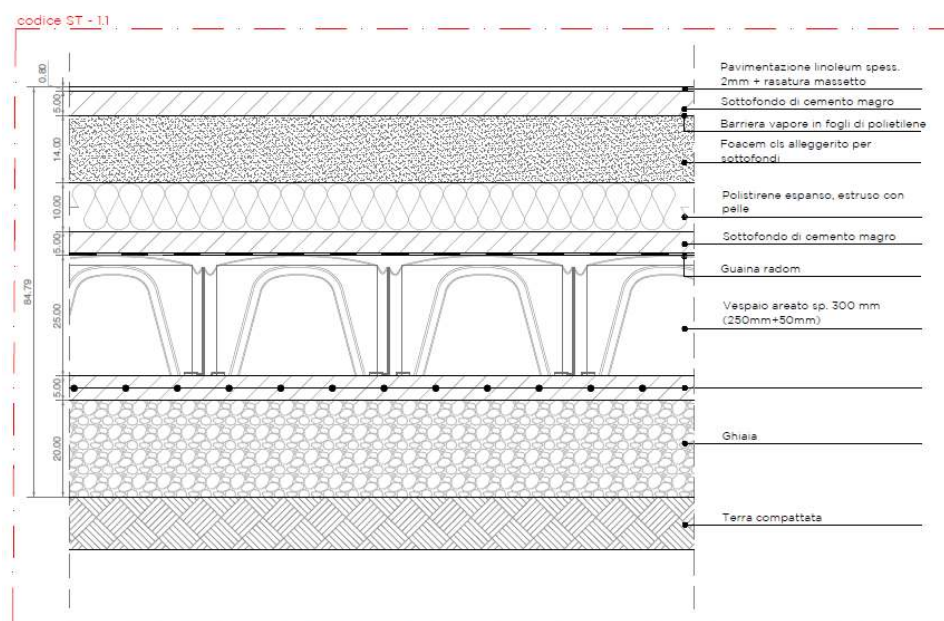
Dettaglio costruttivo pavimentazione. Estratto Tav.04.2_Stato di progetto_Sezione e dettagli
